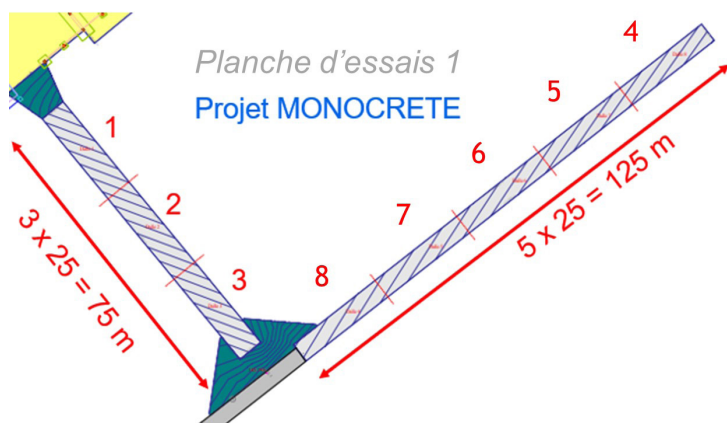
Première planche d'essais du projet MONOCRETE (Bierset, novembre 2022)
